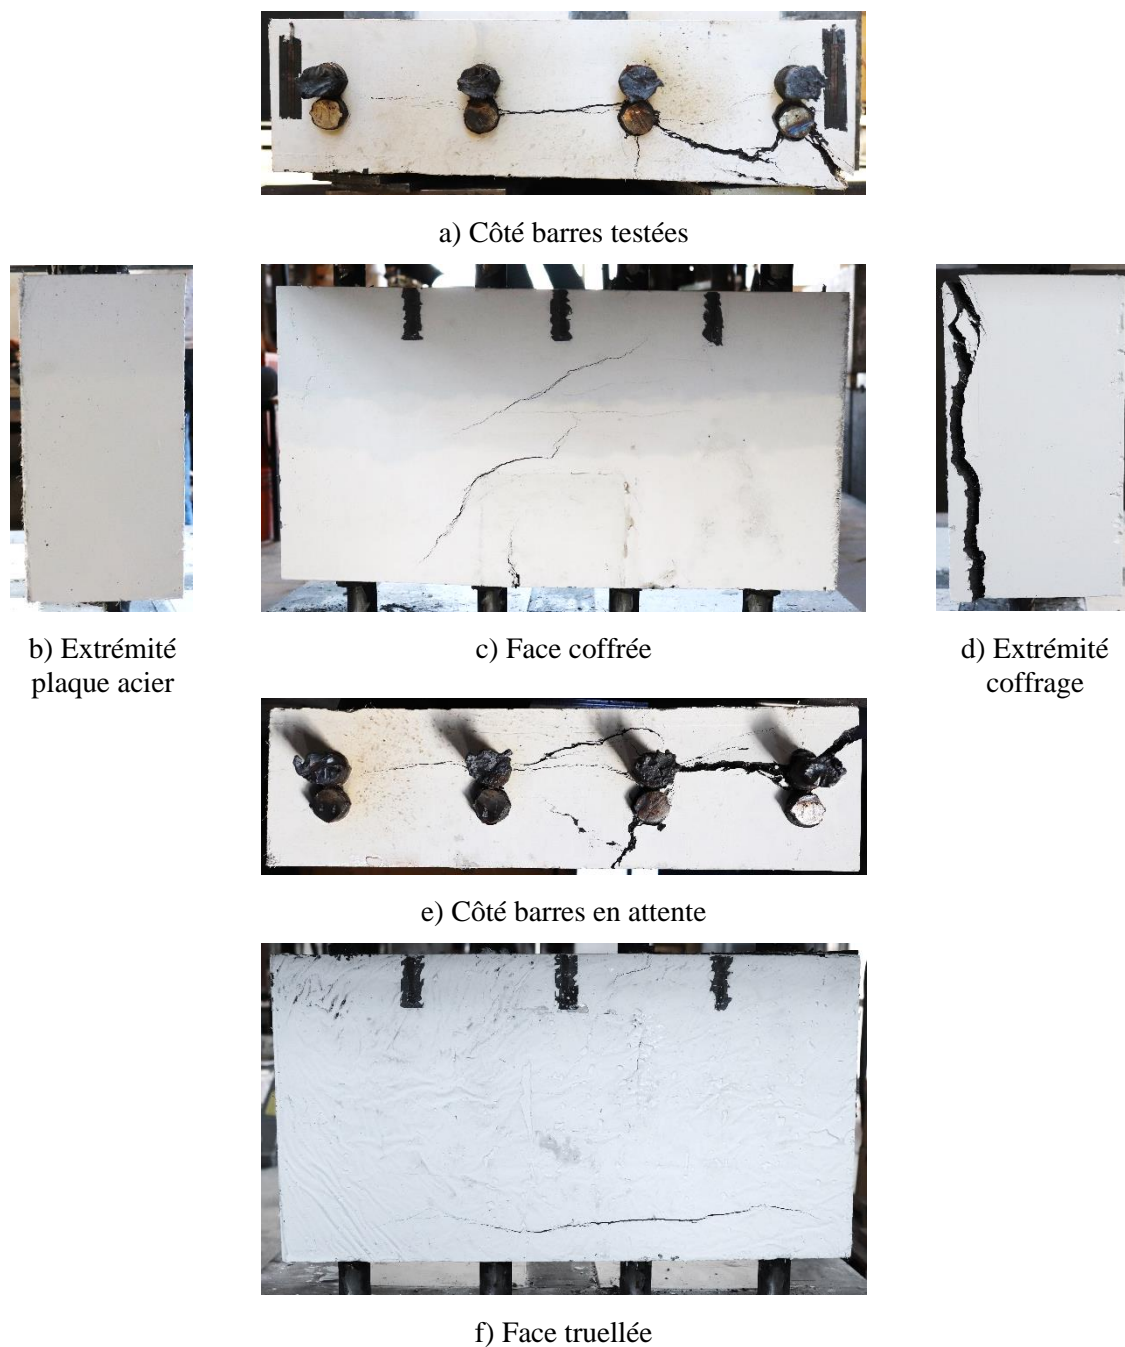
Fissuration observée en laboratoire - Spécimen CT
